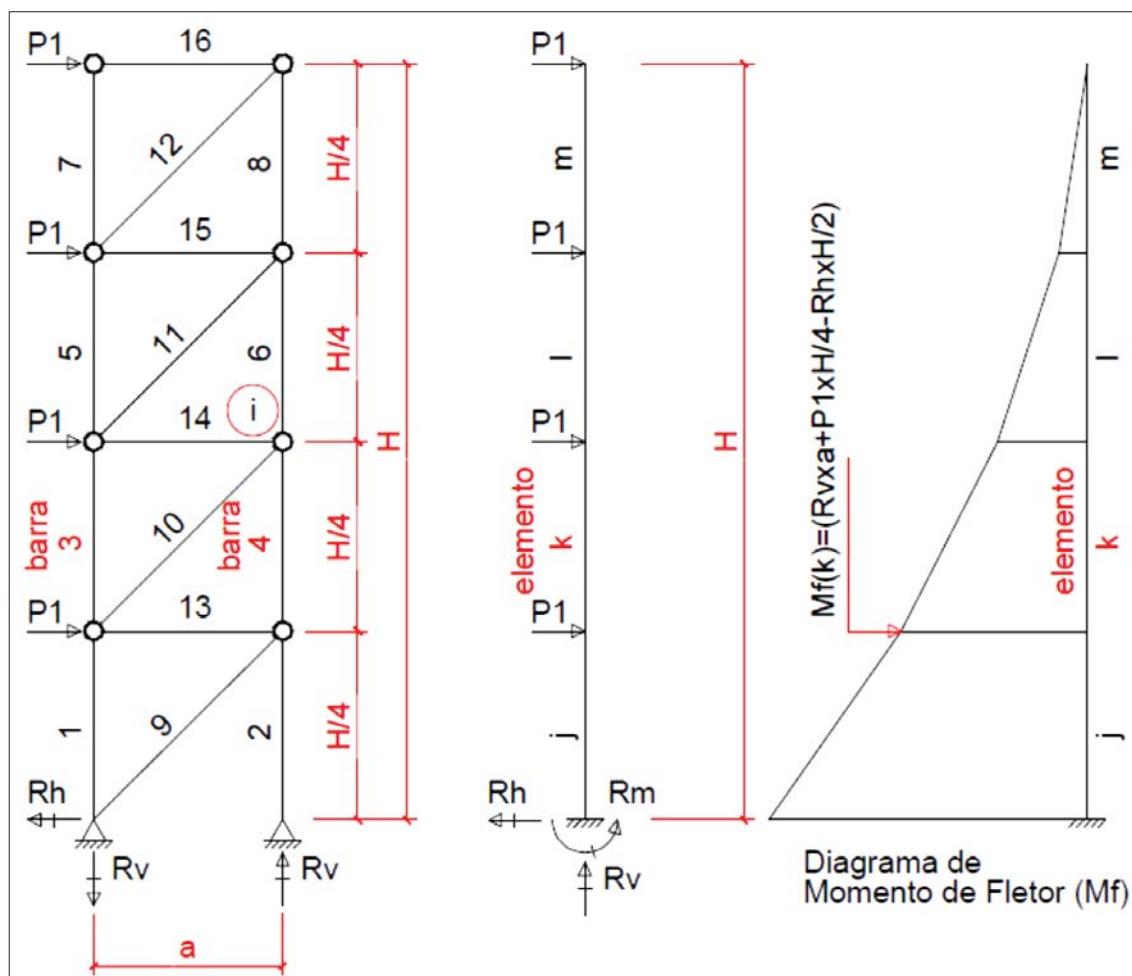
Treliça e a Viga de Substituição (Fonte:autor)
